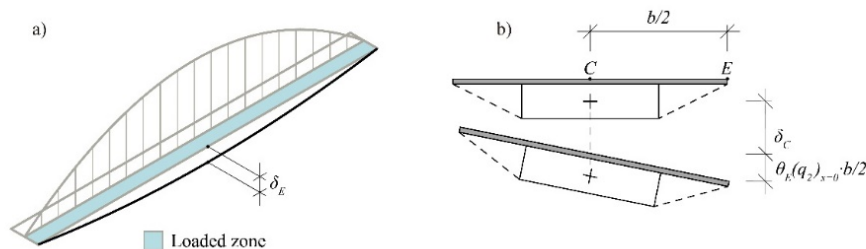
a) deformada del puente para q_2 . b) deformada de la sección transversal del tablero.
